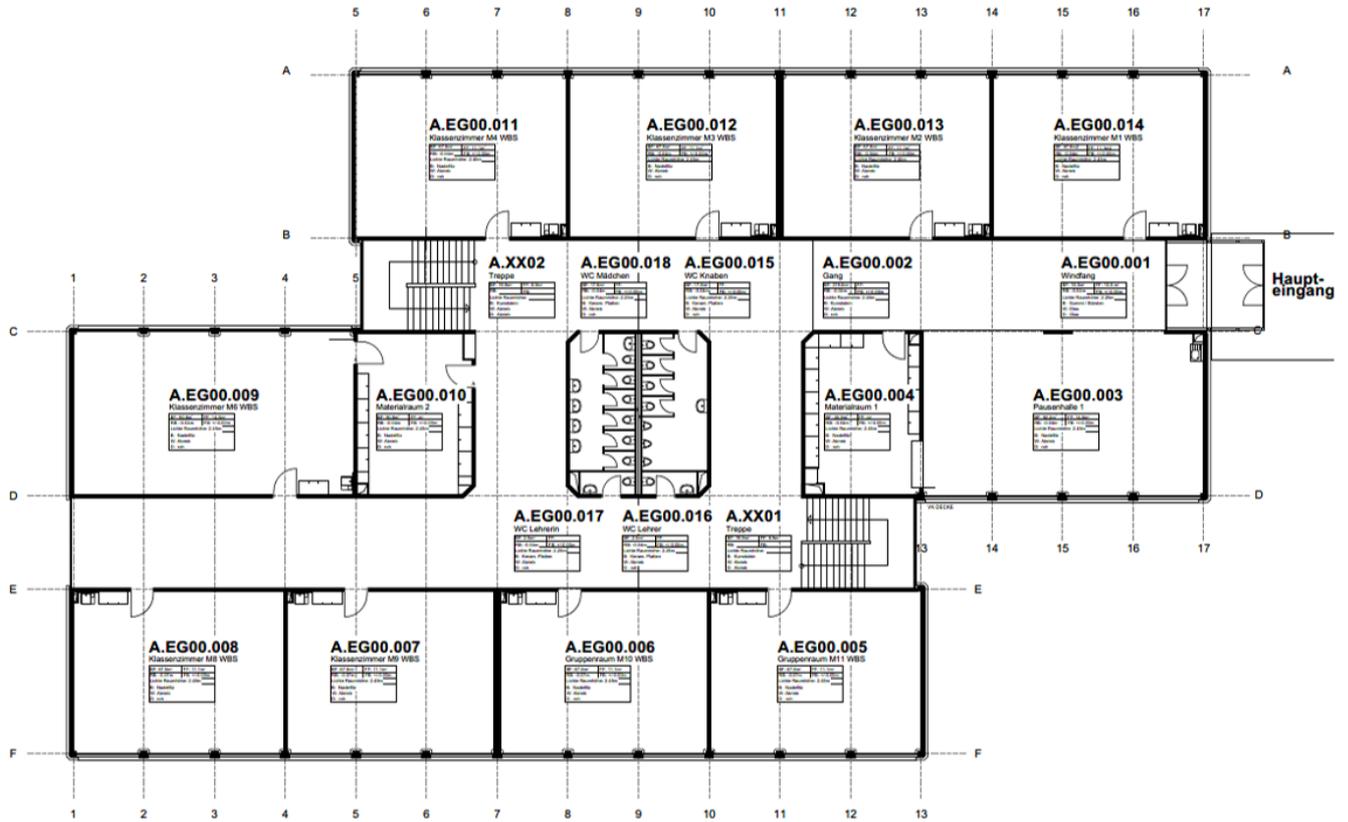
Raumbezeichnung / Raumstempel im Grundrissplan
